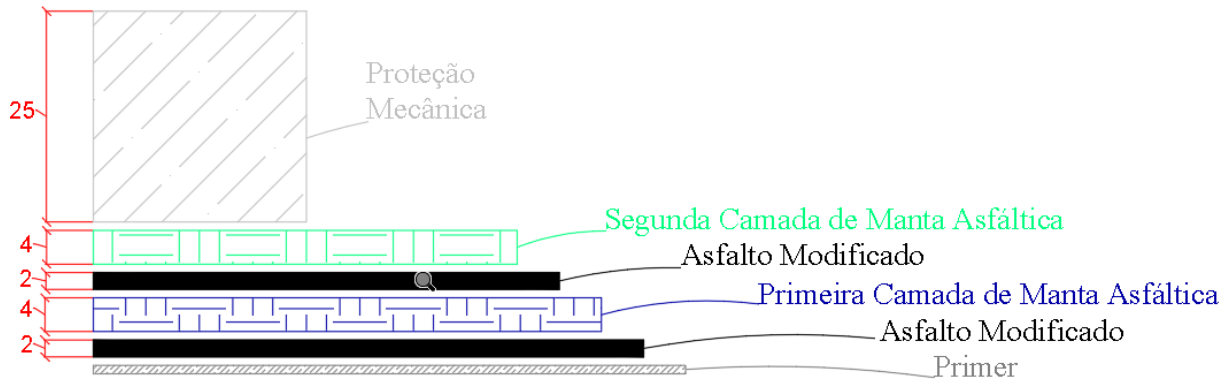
Espessura do sistema de Manta Asfáltica dupla camada – medidas em milímetros (mm)
